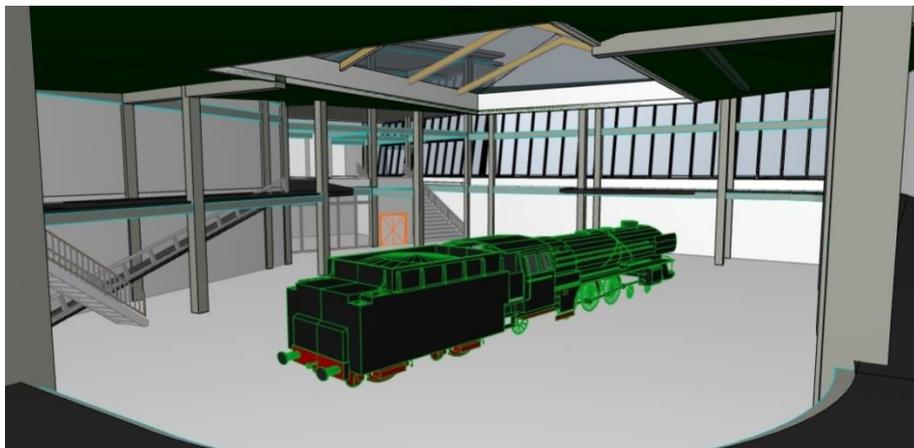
Denah Ruang Pamer 2 (Mezzanine)
